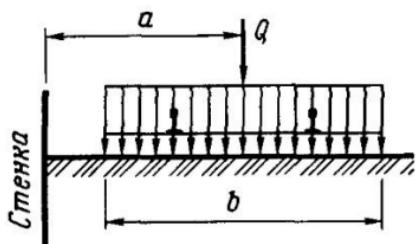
Схема для определения эквивалентной нагрузки от двухрельсовой тележки на призме обрушения
